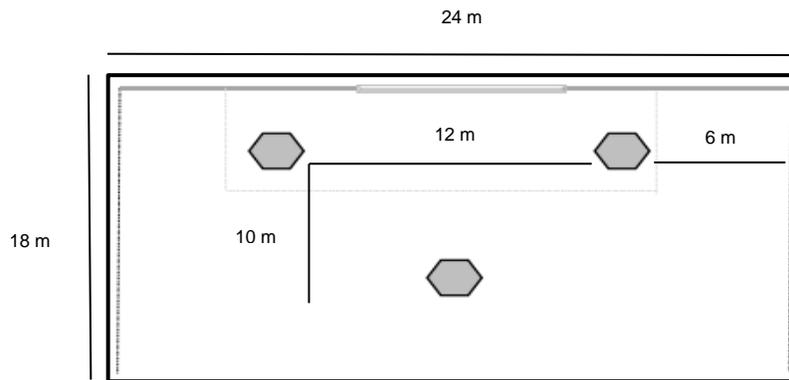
Plano de ubicación equipos de ventilación área de despacho
